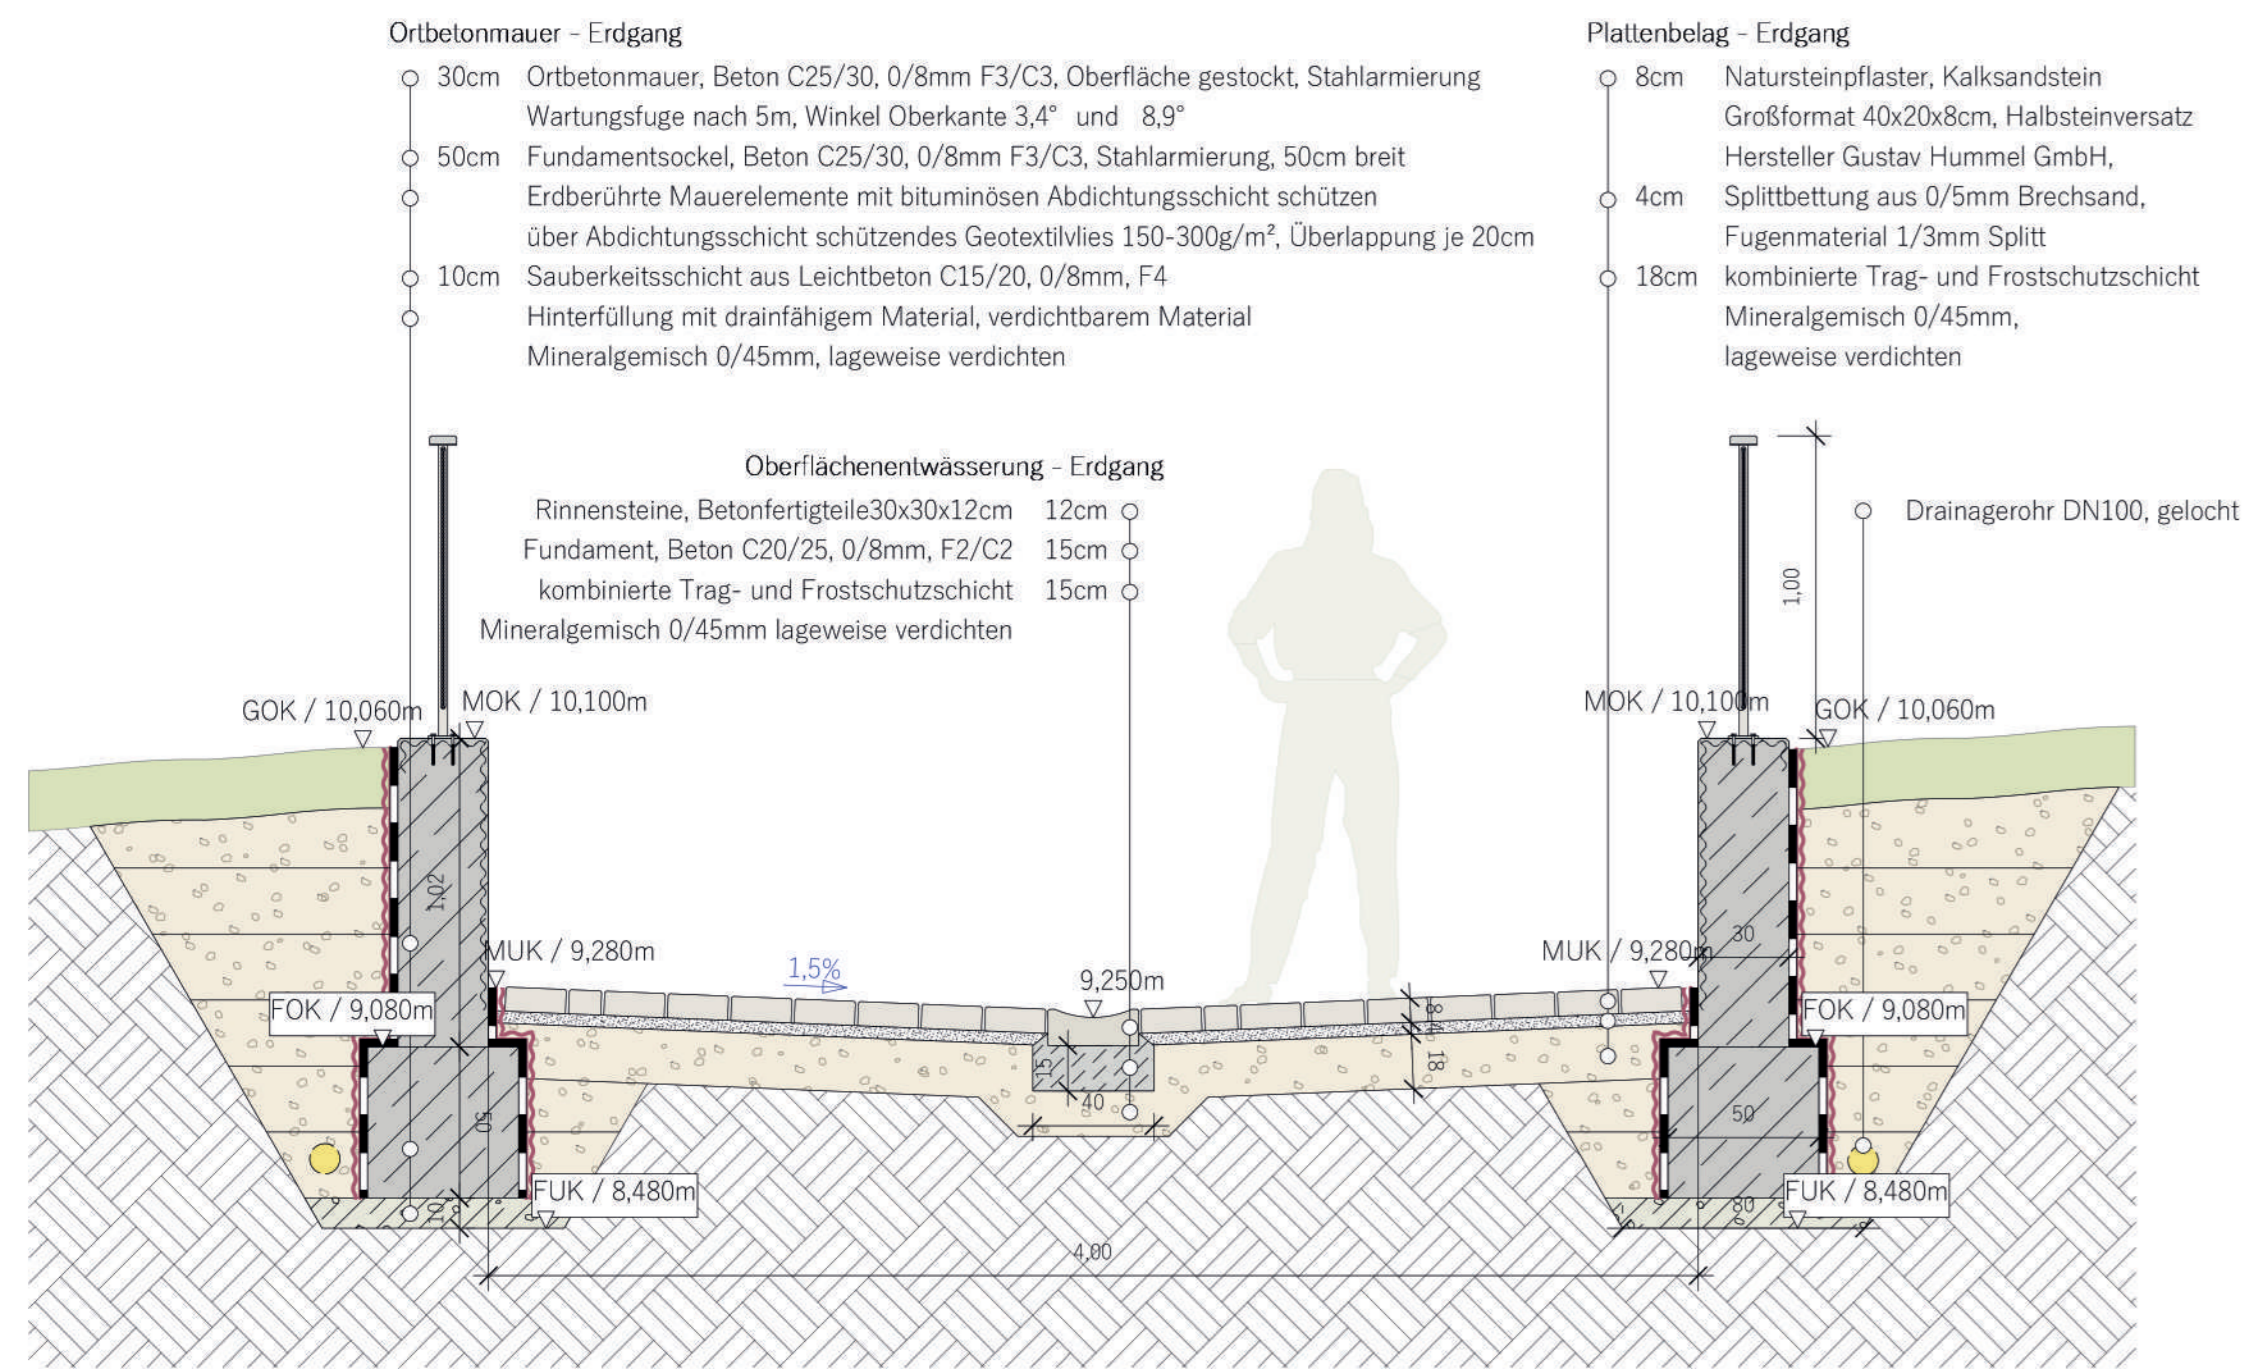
Erdgang mit Erdfenster - Schnittansicht
